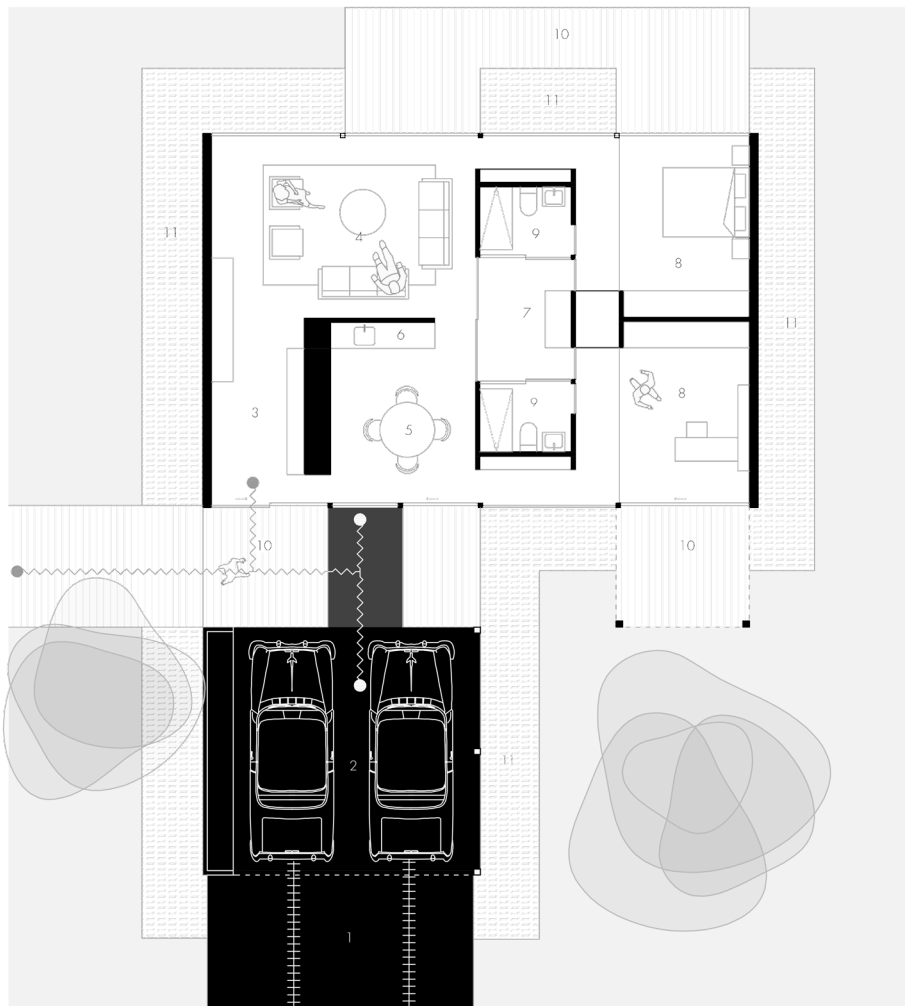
(pag sig sig): Planta *Case Study House N°21B*, Pierre Koenig, 1959. Dibujo de la autora.
